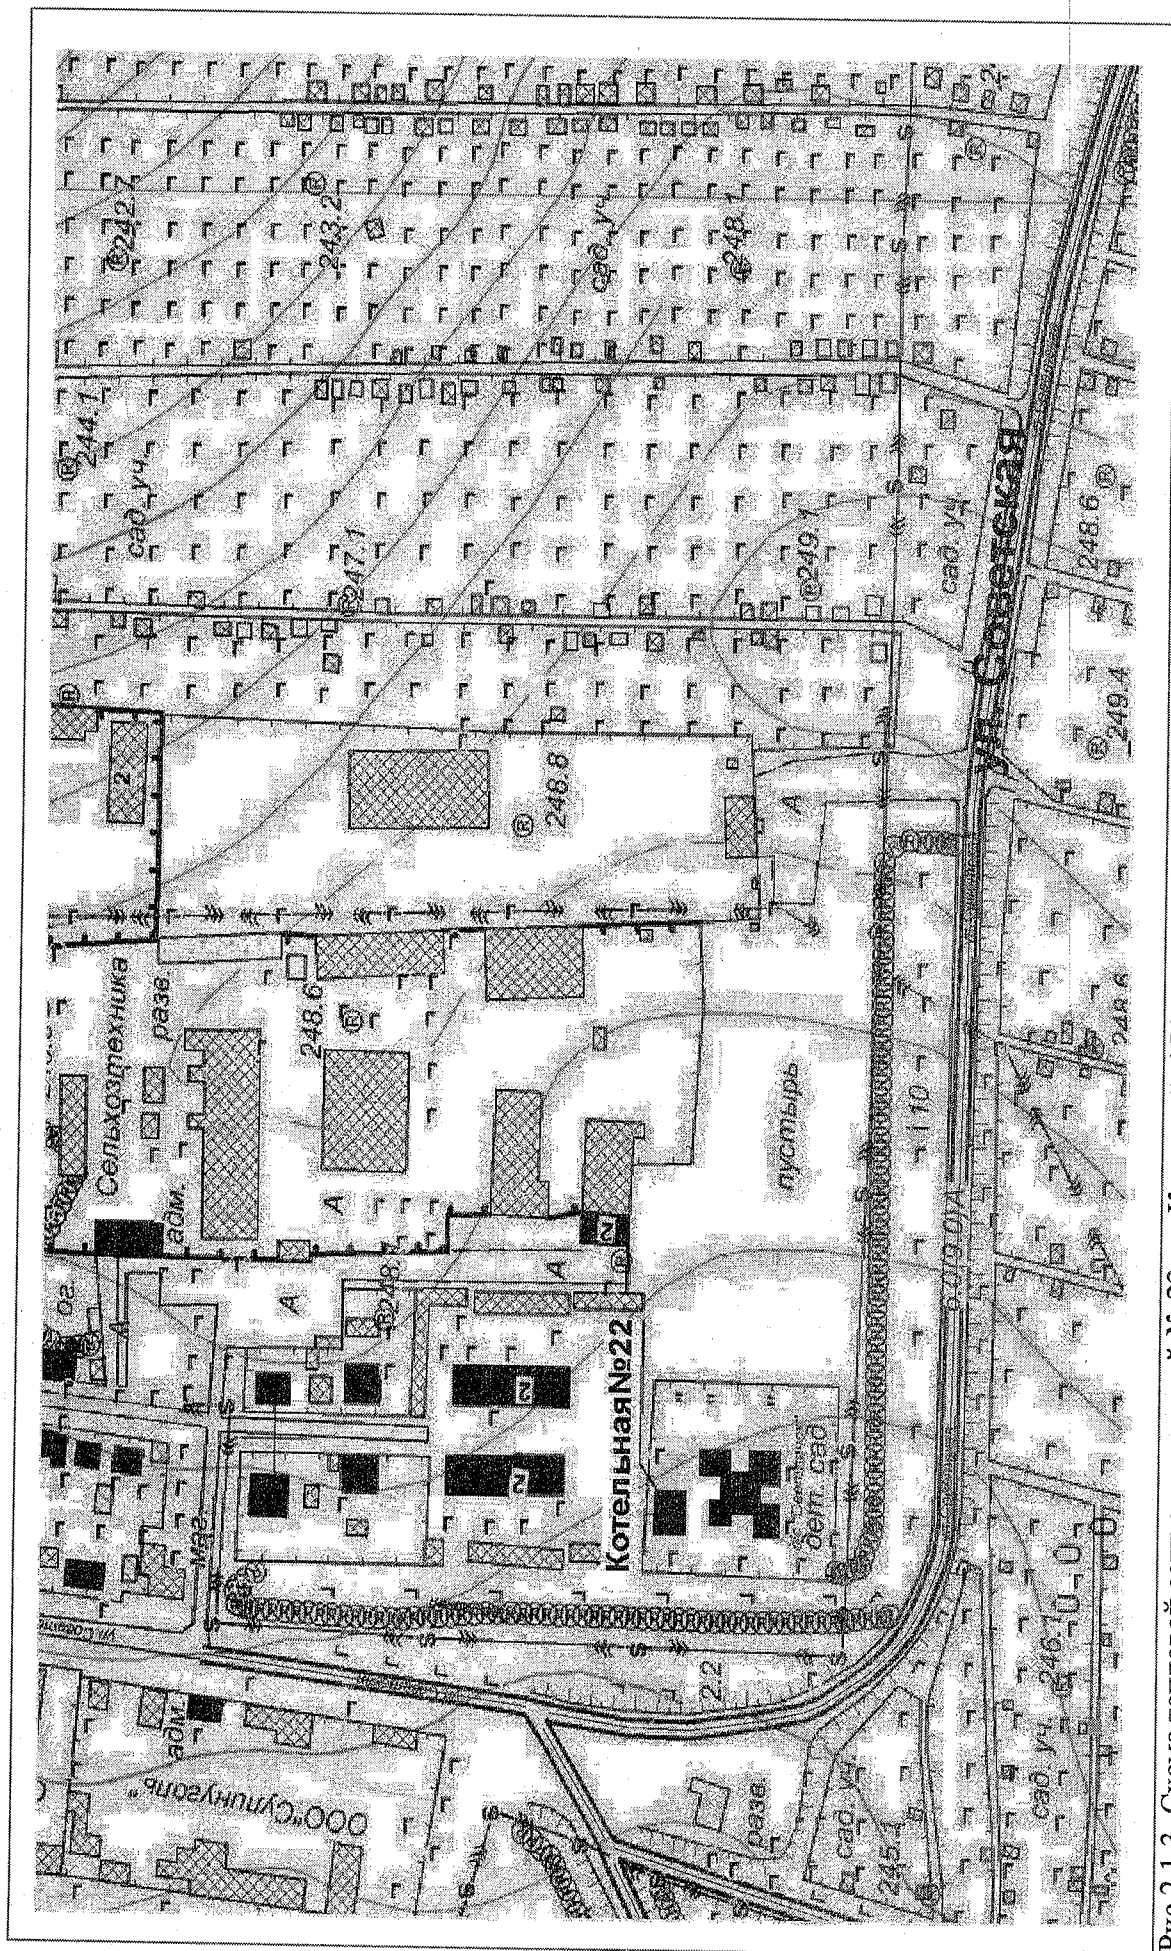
Схема тепловой сети от котельной № 22 ул. Крупской, 154а
